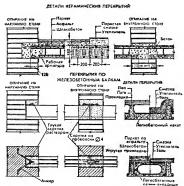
Перекрытия по прогонам керамическим и железобетонным балкам.
